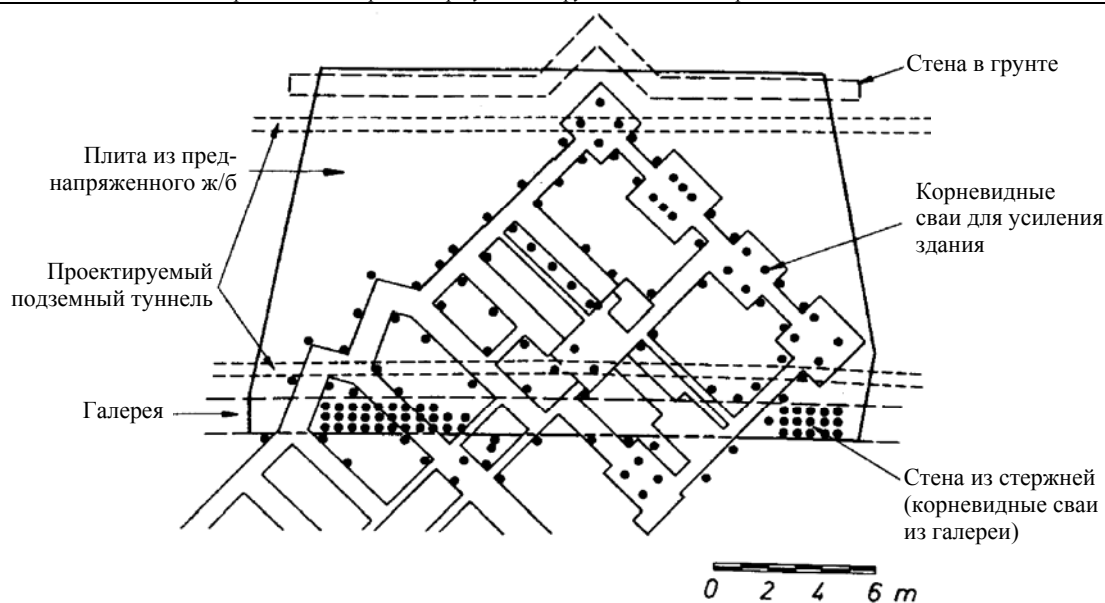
Усиление здания при строительстве метрополитена в Гамбурге: план основания
